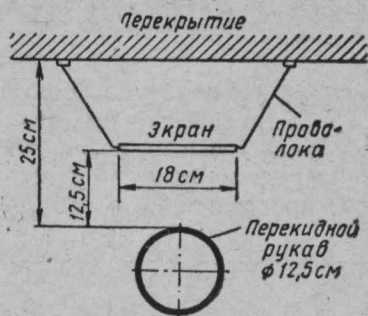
Схема установки металлического экрана между перекидным рукавом нетеплоемкой печи и сгораемым перекрытием.
